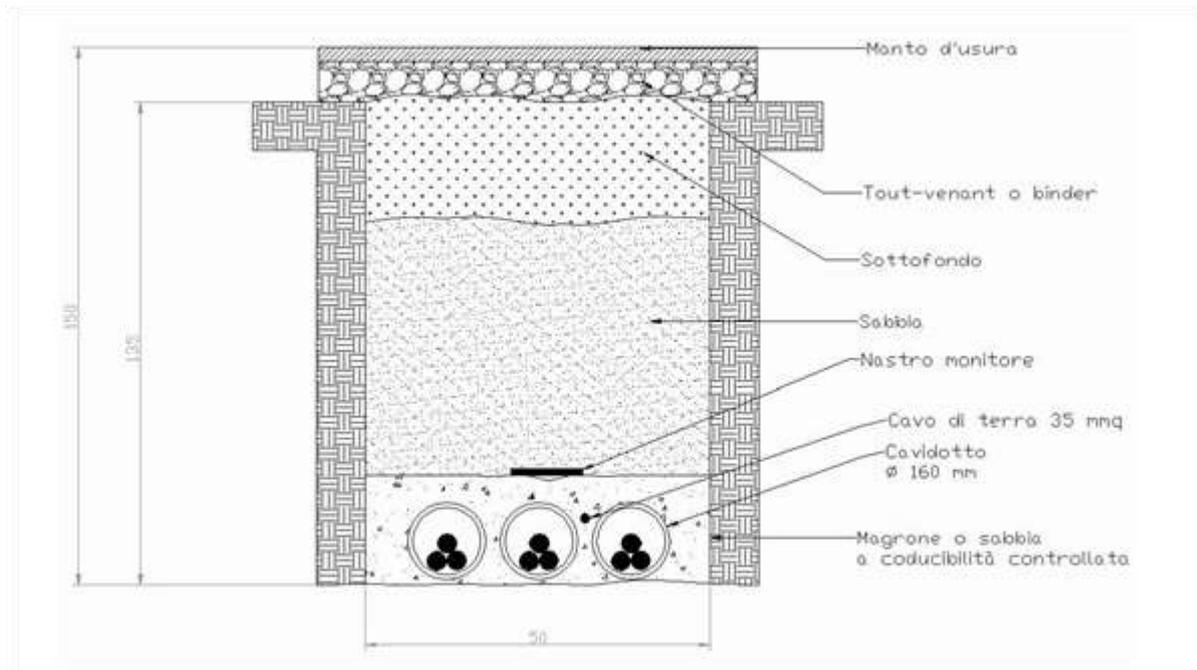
Sezione tipo di posa con n° 3 terne di cavi
